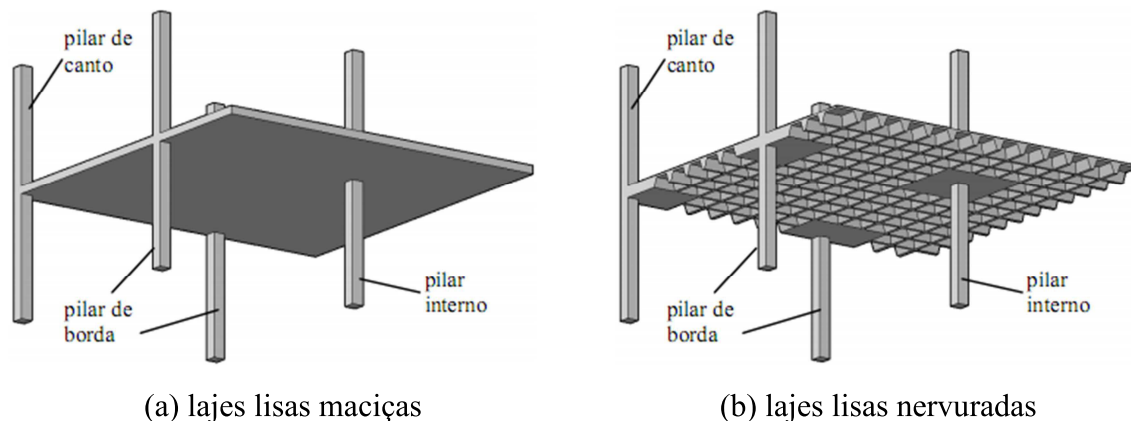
Sistemas estruturais em lajes lisas (Ferreira, 2010)
